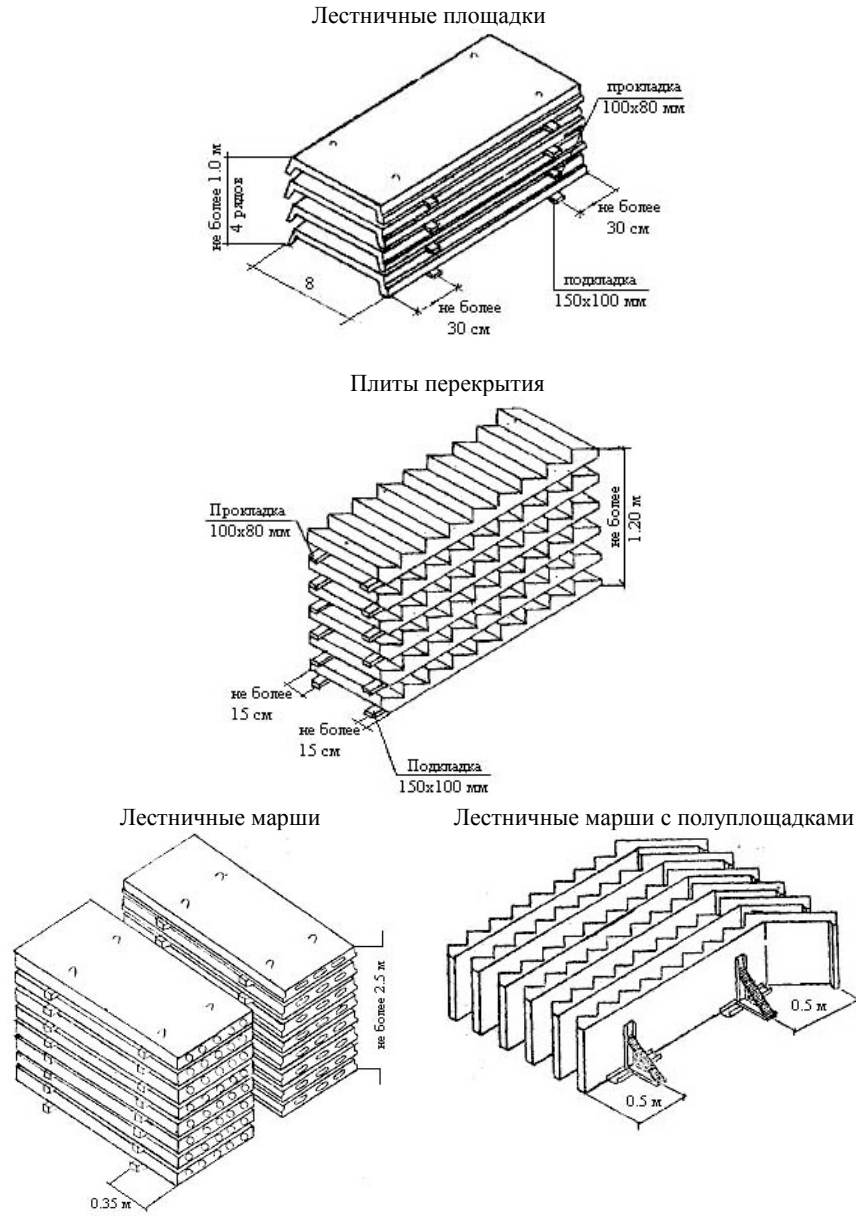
Схемы размещения на складе железобетонных изделий
